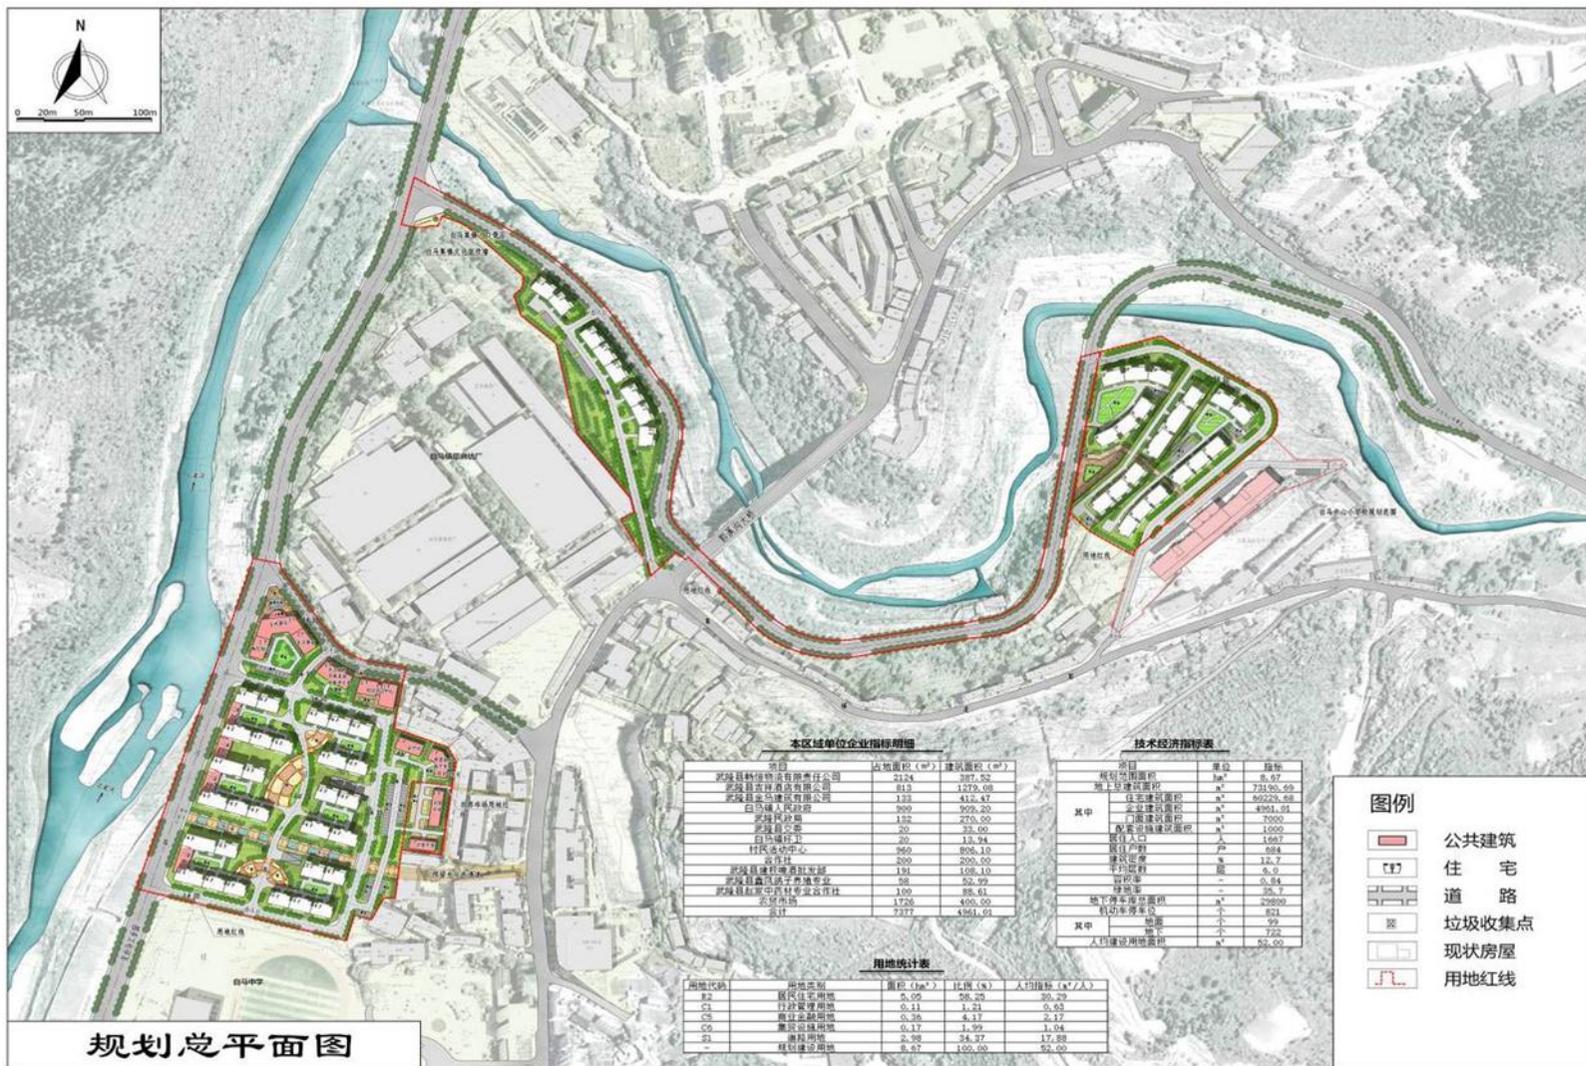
白马集镇移民迁建区总平面布置图
